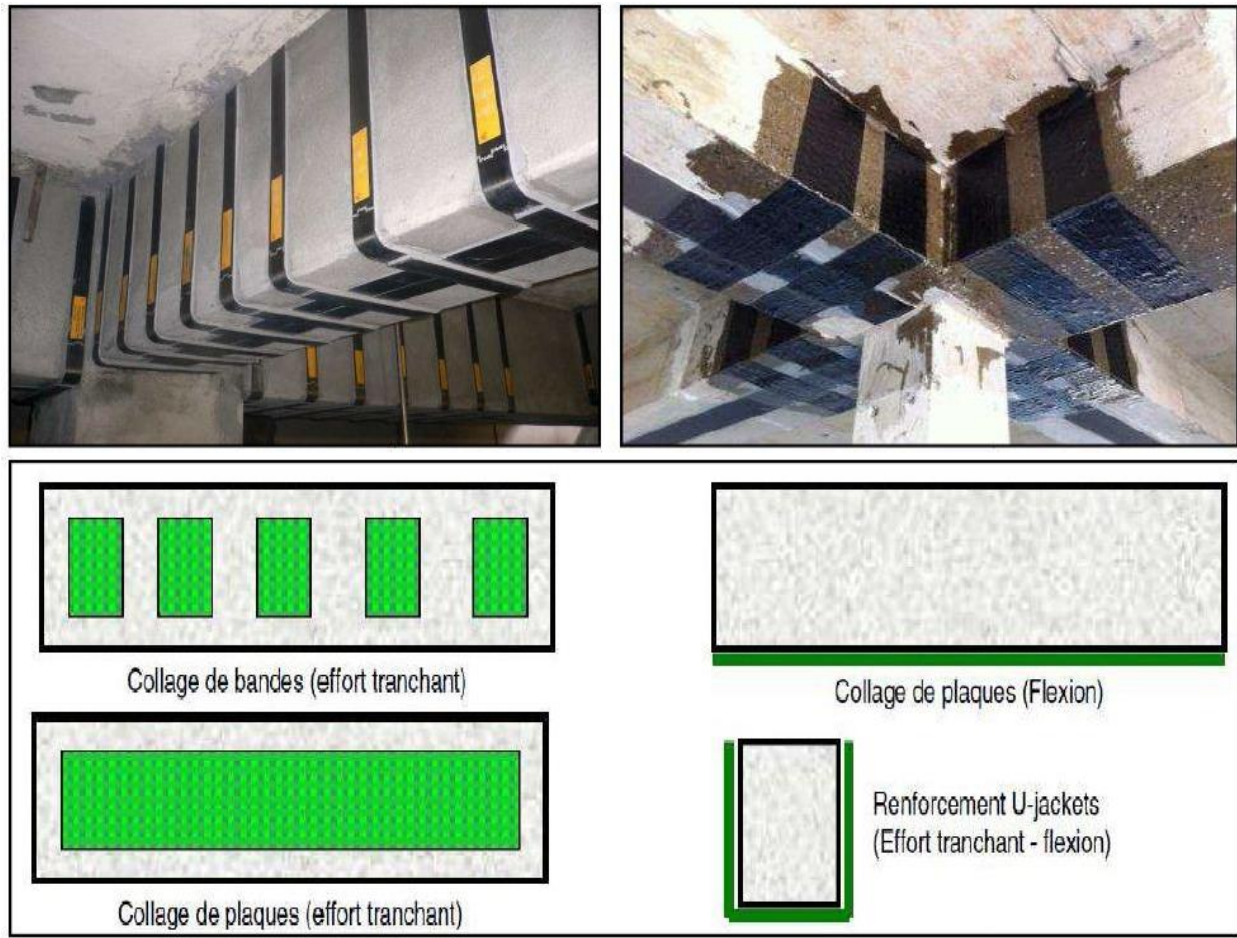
Différentes techniques de renforcement des poutres en béton armé [12]
